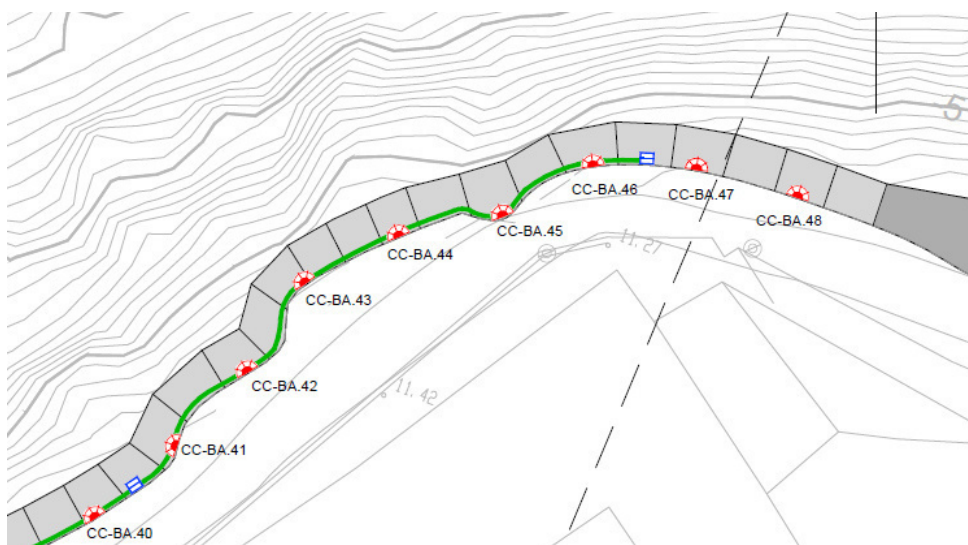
Propuesta de instalación eléctrica en planta en el tramo de muelle de pasarela metálica.
